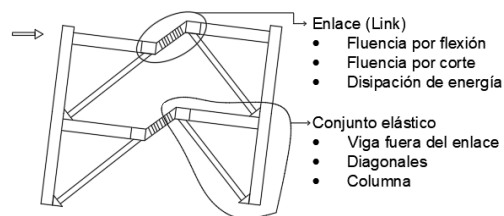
Deformada de un pórtico ante cargas laterales.
